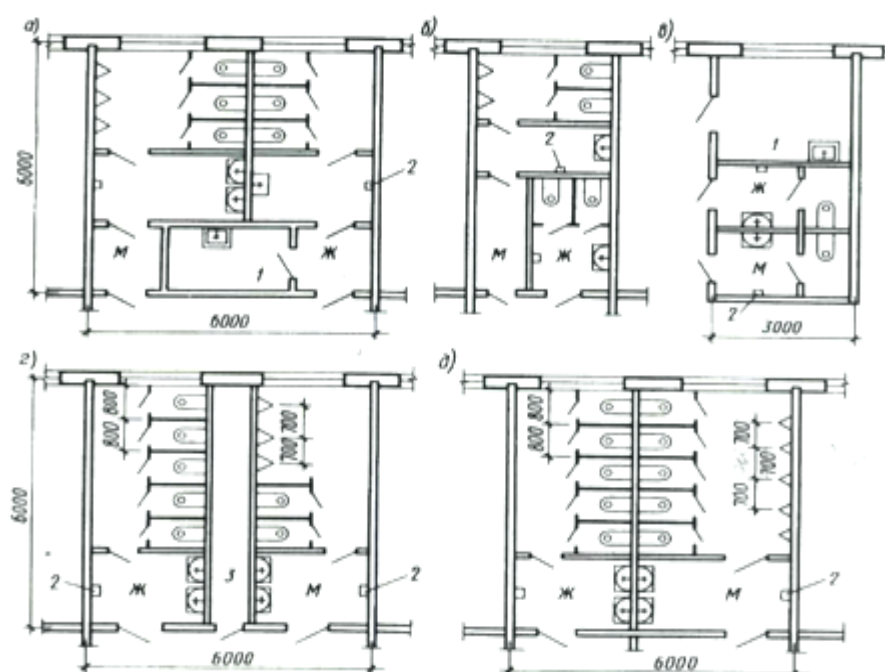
Приклади планувальних рішень санвузлів:
